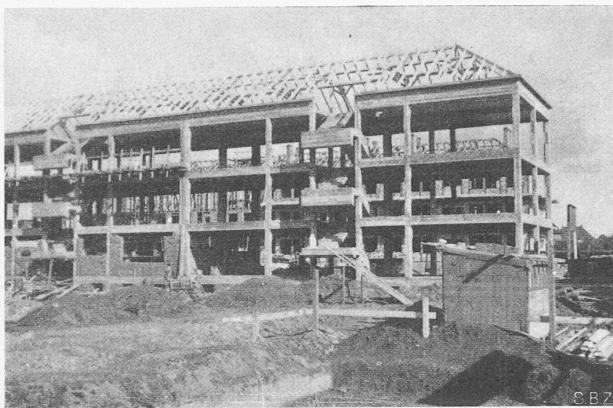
und 11. Eisenbetonskelett-Baublock der Baumesse-Siedlung in Leipzig; Ausfachung noch unvollendet.
